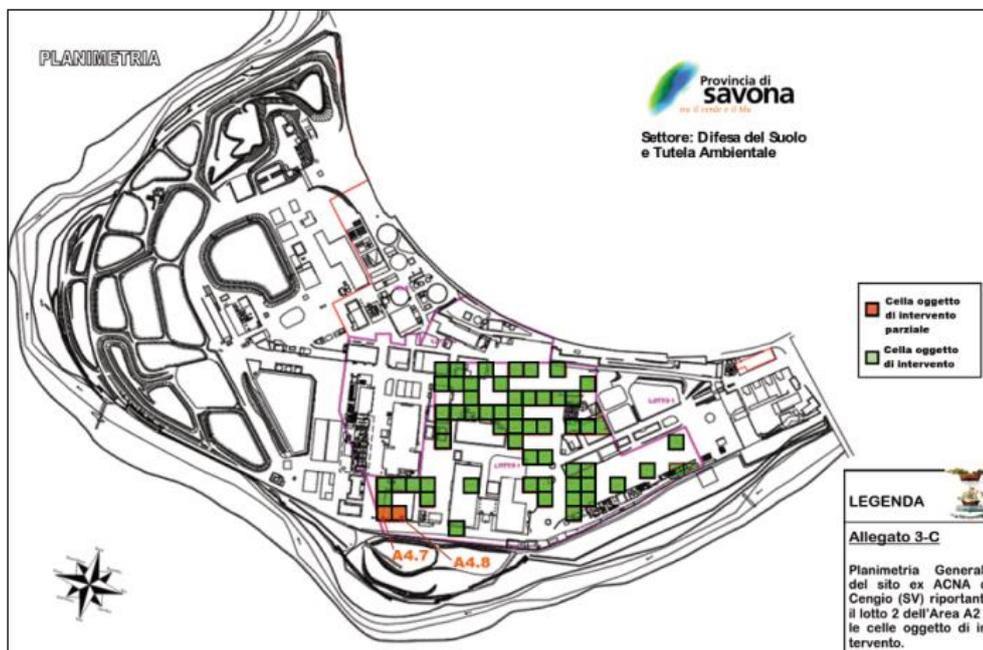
Planimetria Generale del sito ex ACNA di Cengio (SV) riportante il Lotto 2 dell'Area A2 e le celle oggetto di intervento
